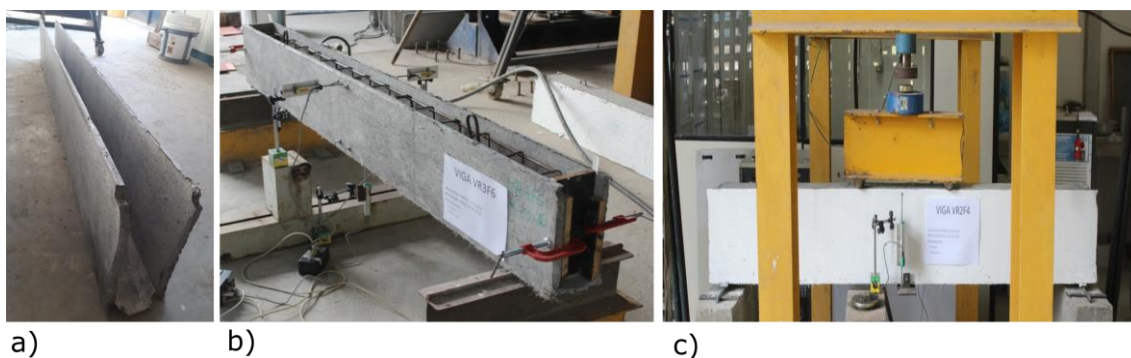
Processo de produção e ensaio das vigas: a) forma permanente; concretagem das vigas; c) ensaio de flexão
